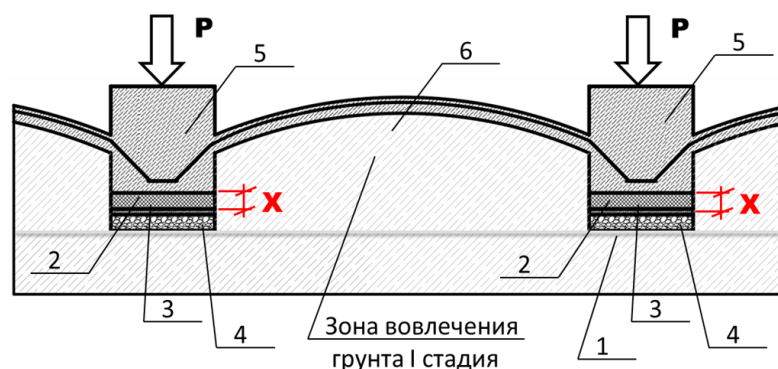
Этапы работы фундамента: I стадия, где 1 - грунтовое основание; 2 - прокладка из пенополистирола; 3 – бетонная подготовка; 4 – щебеночная подготовка; 5 - опорные железобетонные контуры; 6 – грунт подбололочной части до обжатия
